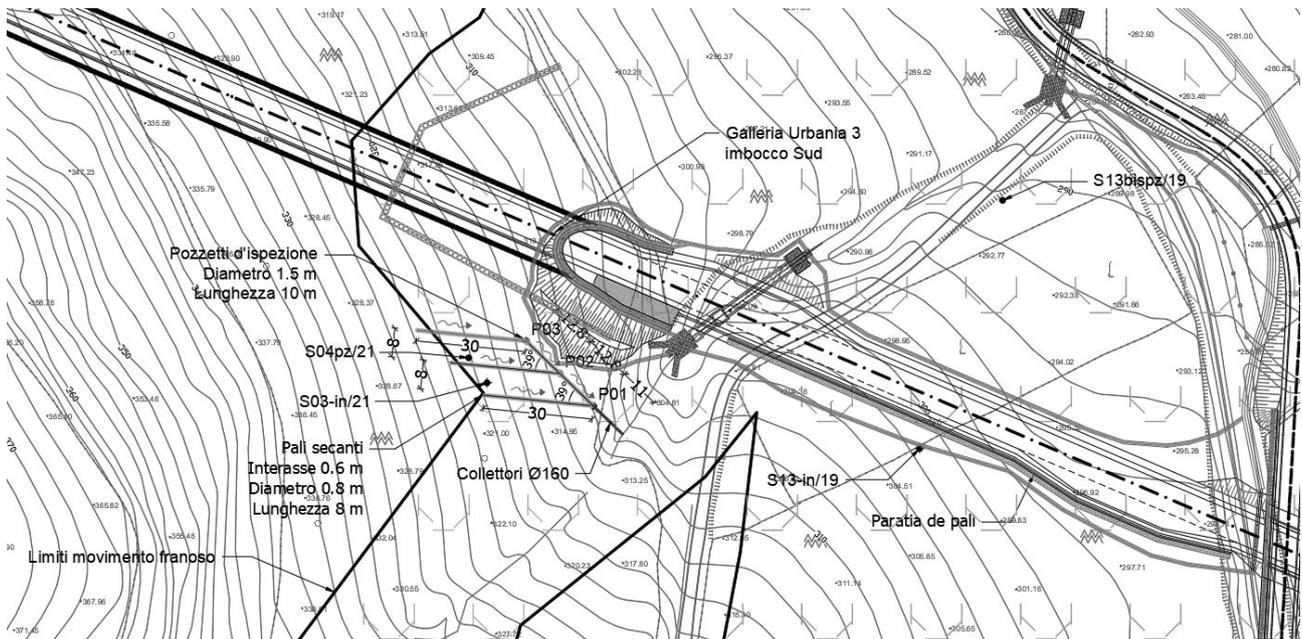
Schema della disposizione in pianta del sistema drenante costituito da pali secanti
